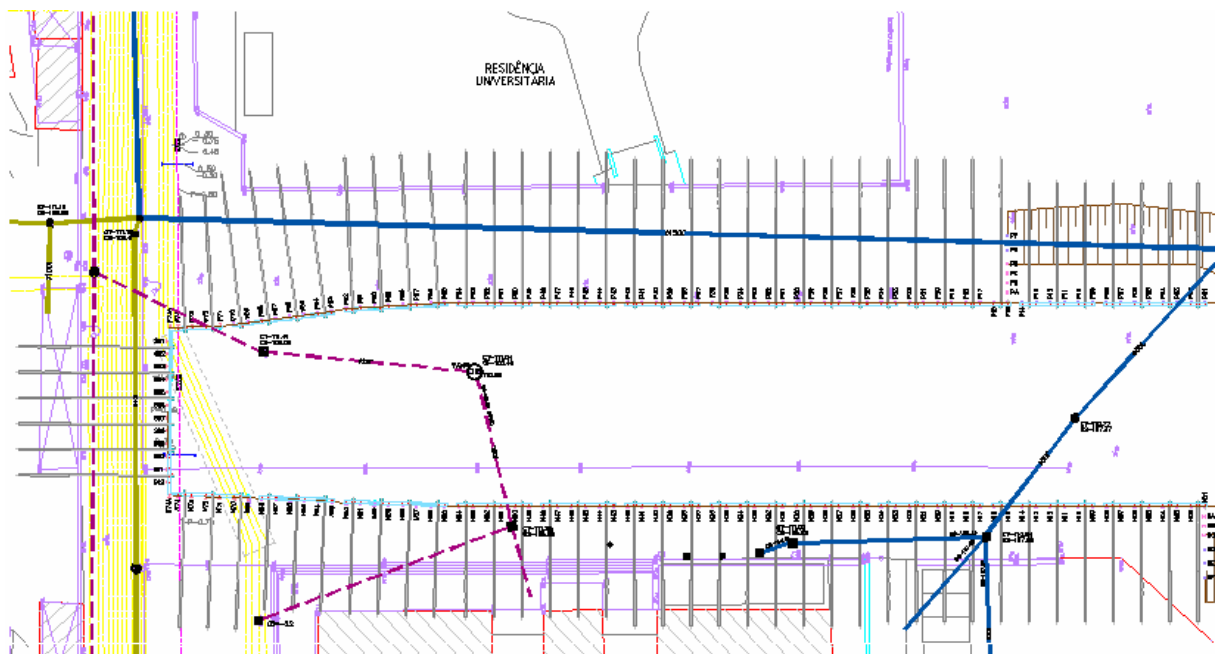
Planta da contenção provisória “tipo Berlin”
